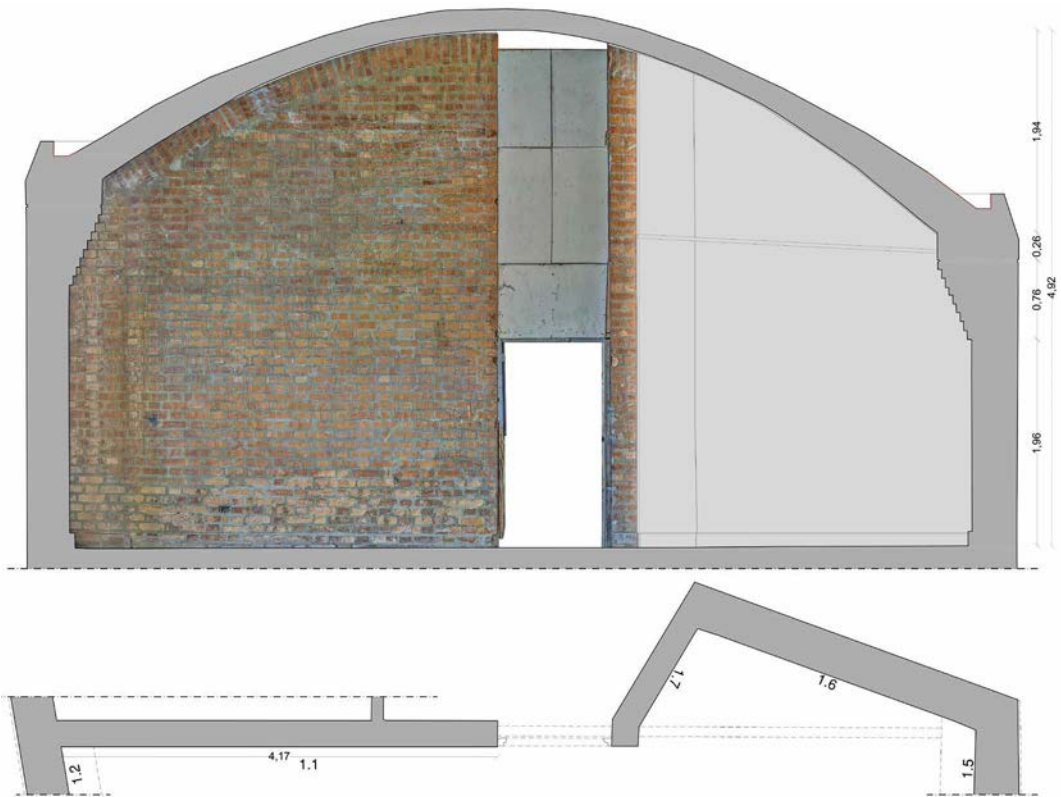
| Fotoplano de la pared 1.1 (Bloque 1). | Fotoplano della parete 1.1 (Blocco 1).
